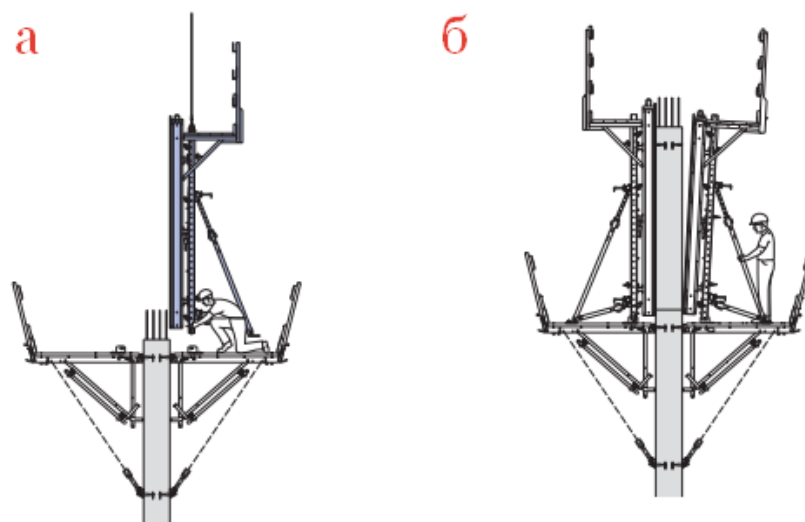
Установка (а) и распулубливание (б) подъемно-переставной опалубки К [23]
